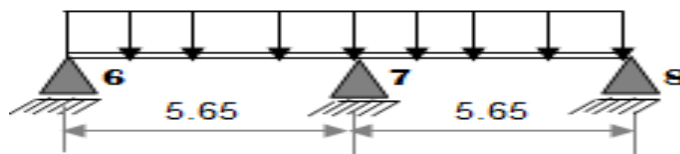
Schéma des poutrelles de plancher inaccessible de bloc B
